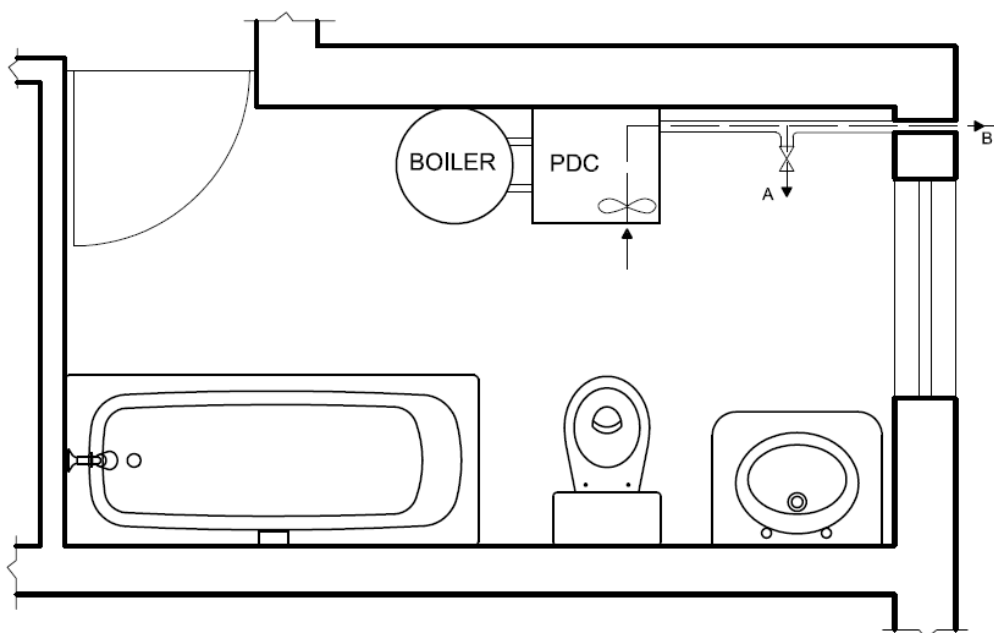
Esempio di installazione dell'impianto proposto in locale da bagno
